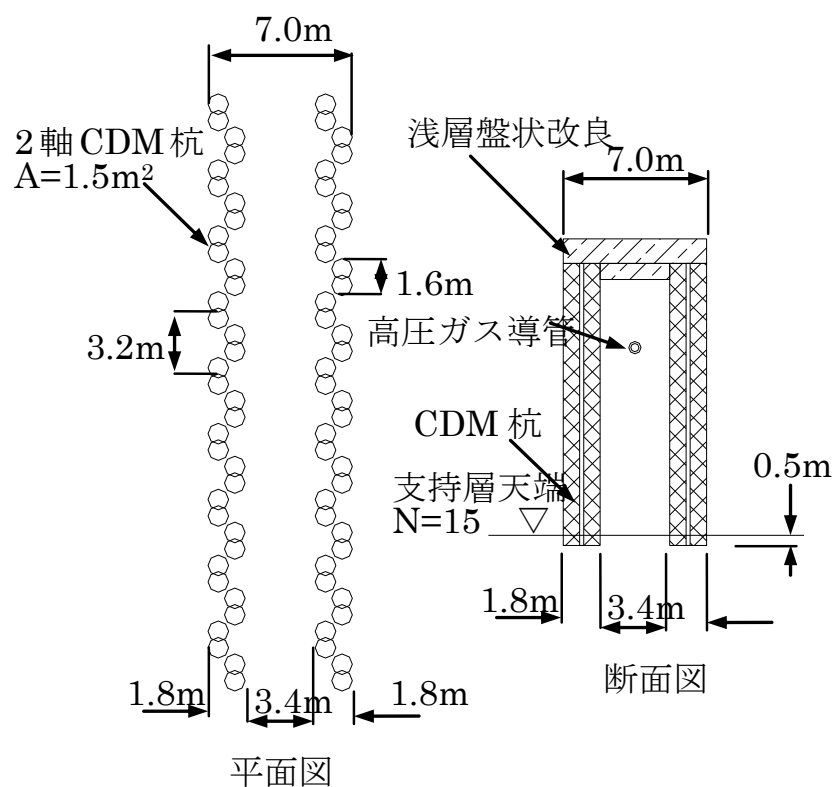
TYPE-3 の改良杭配置(左：平面図，右：断面図)
